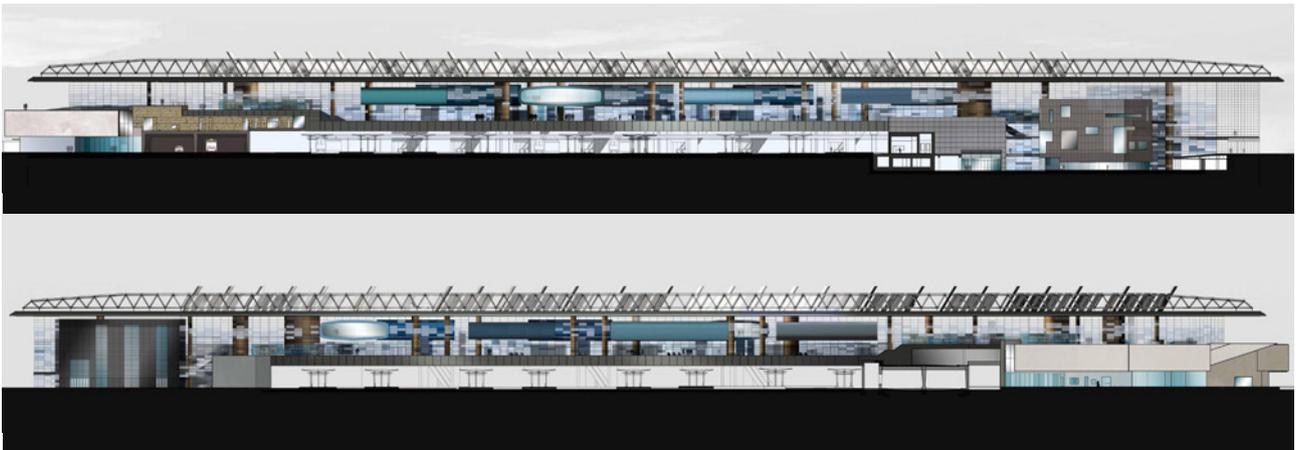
(in alto) La piastra ponte dalle banchine; Fig. 108. (in basso) Prospetto nord e sud della piastra ponte (di concorso)
